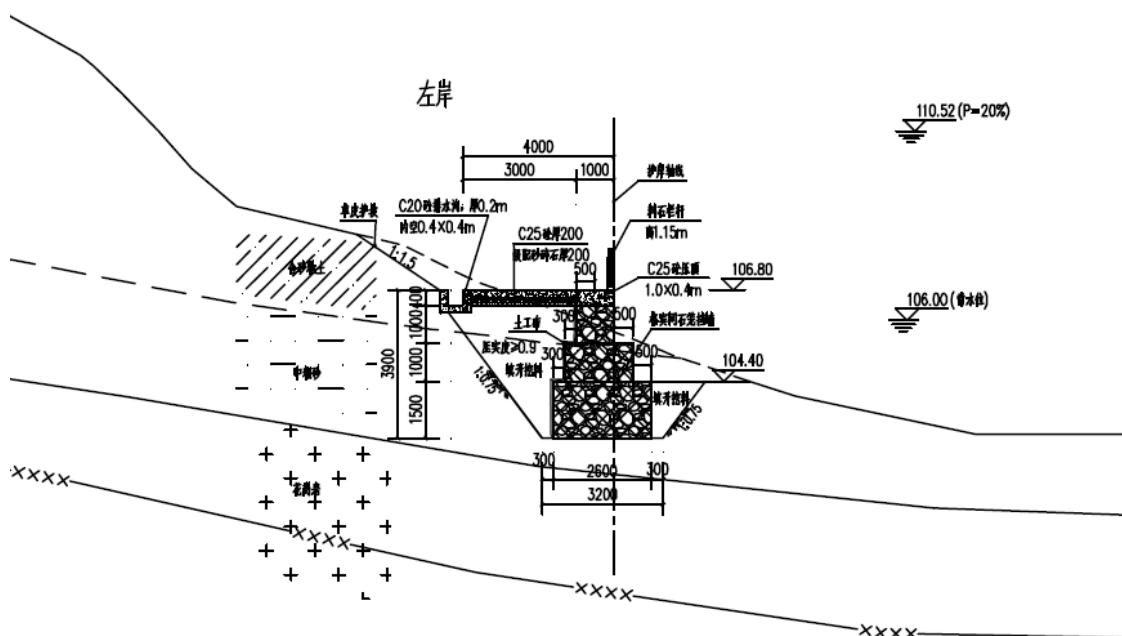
格宾网笼结构+草皮护岸典型剖面图
